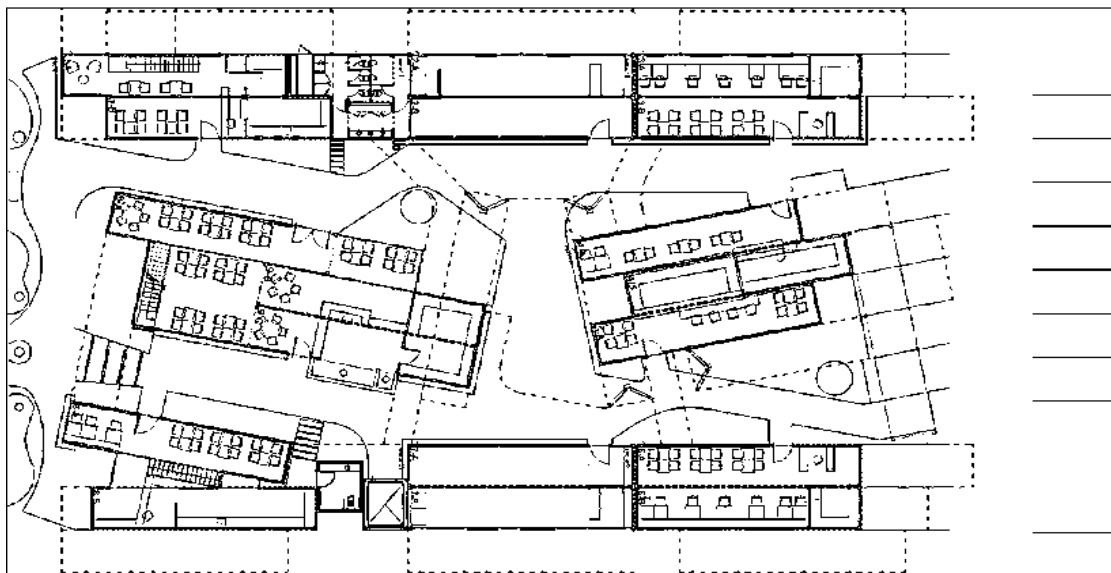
Planta baja de conjunto de Quo Container Center. Fuente: ARQA Arquitectura Sustentable.
